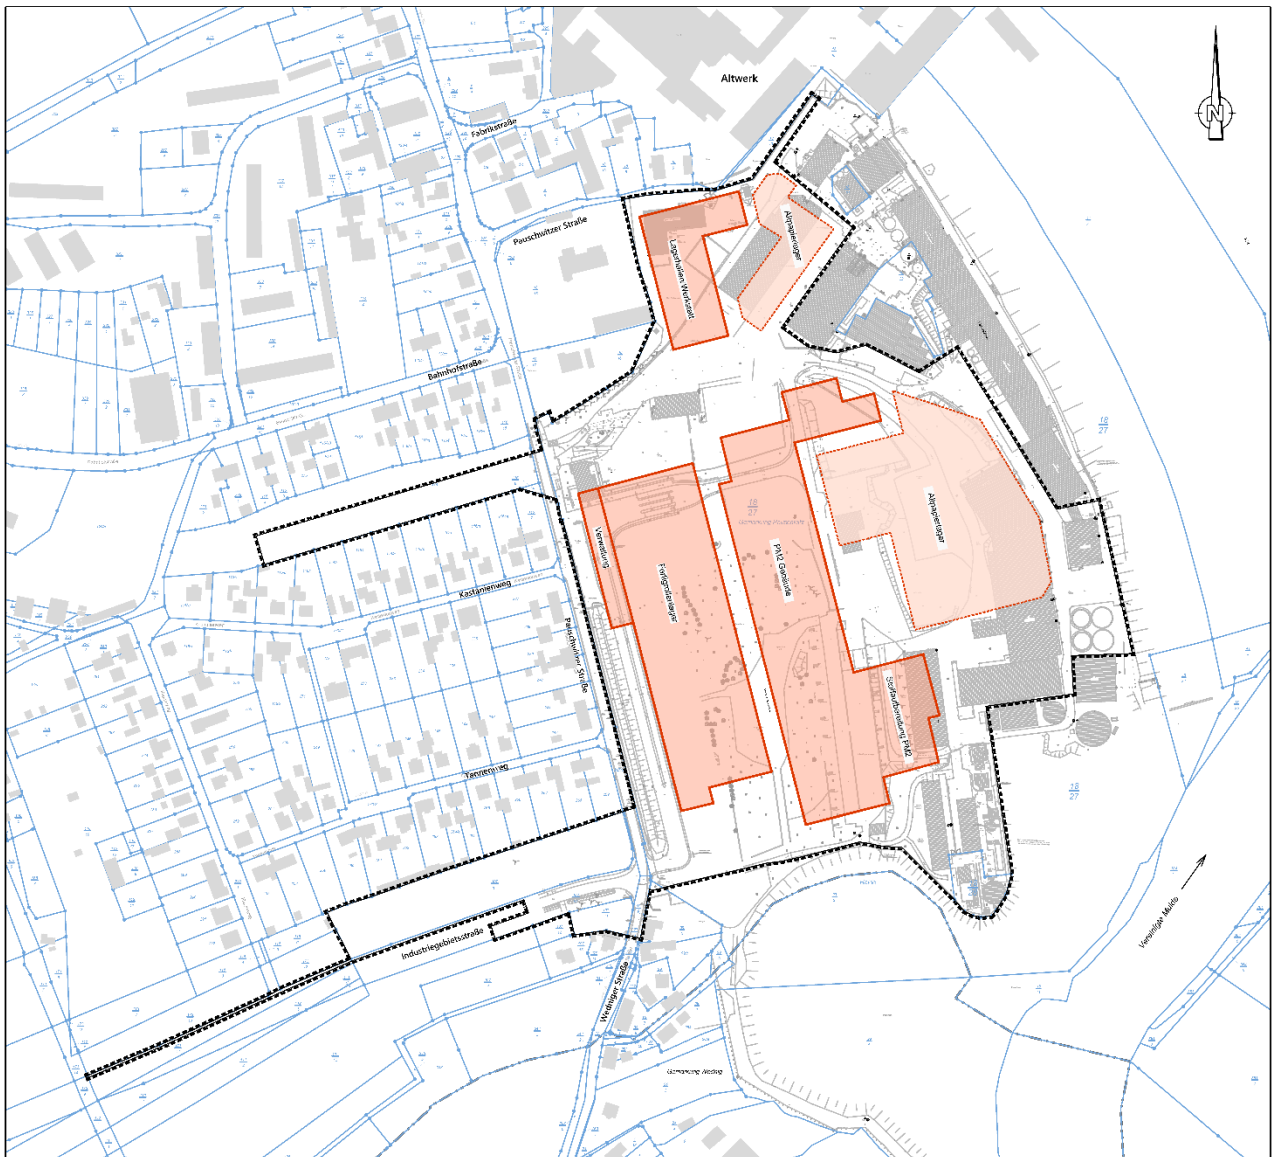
Generalisierte Darstellung eines möglichen Layouts,
